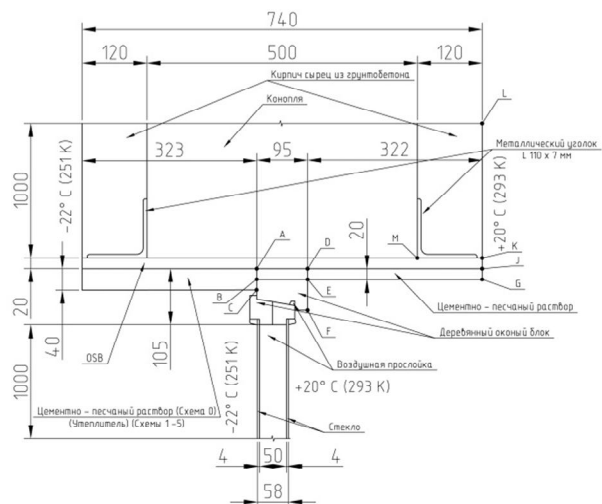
Конструктивное решение узла сопряжения окна со стеной / Structural decision of knot interface of window with a wall
